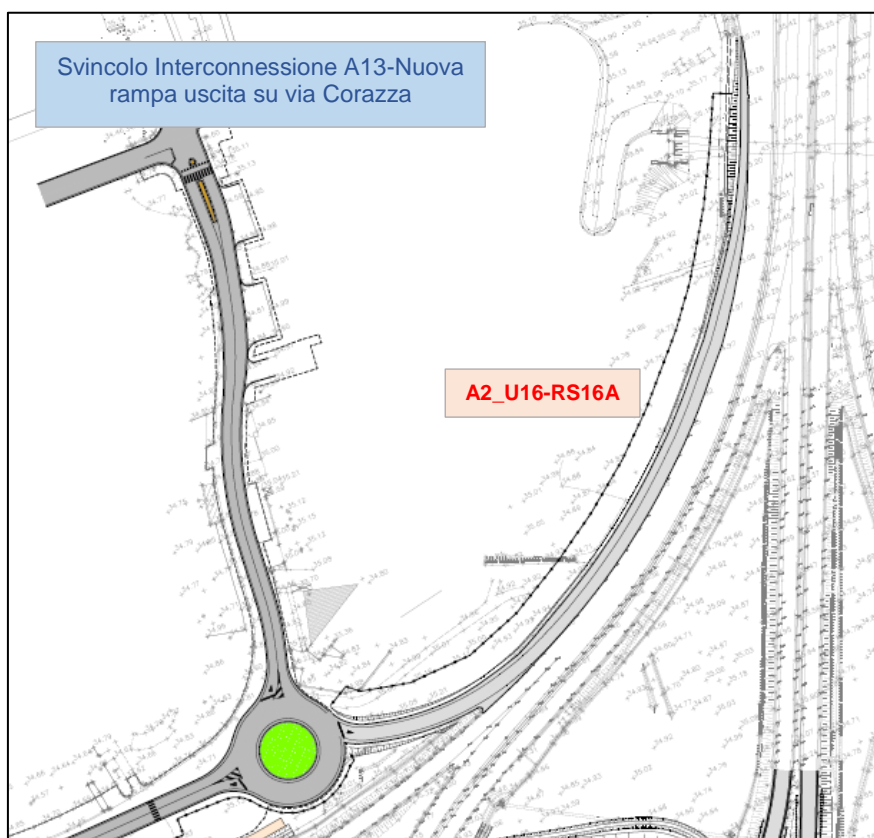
Stralcio planimetrico svincolo Interconnessione A3-Nuova rampa uscita su via Corazza
